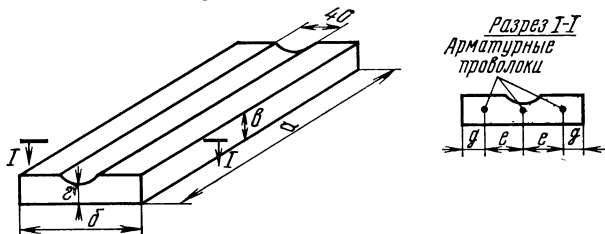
Бетонные подкладки для бетонных прямоугольных труб
